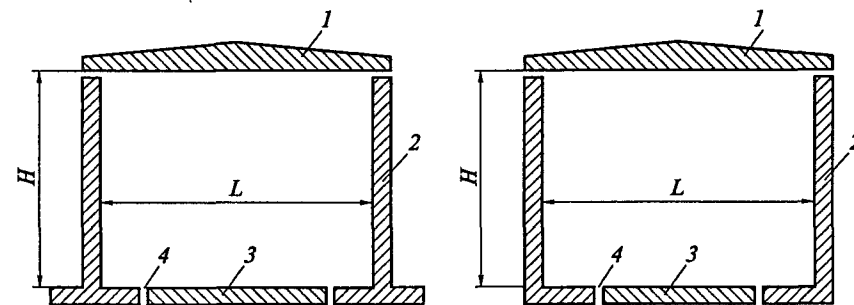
Конструкция прямоугольных труб из сборных блоков: 1 — блоки перекрытия; 2 — стеновые блоки; 3 — лотковые блоки; 4 — стык омоноличивания
